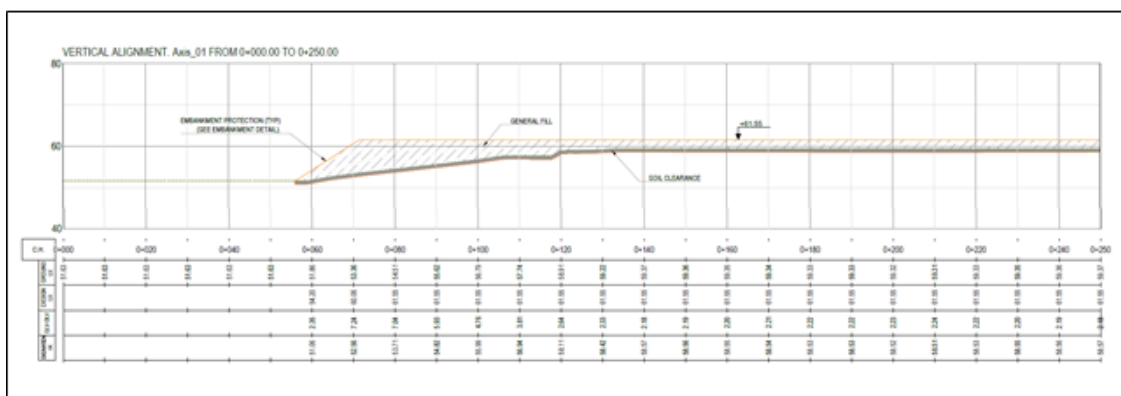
Corte longitudinal de nivel del terreno y propuesta de refulado
